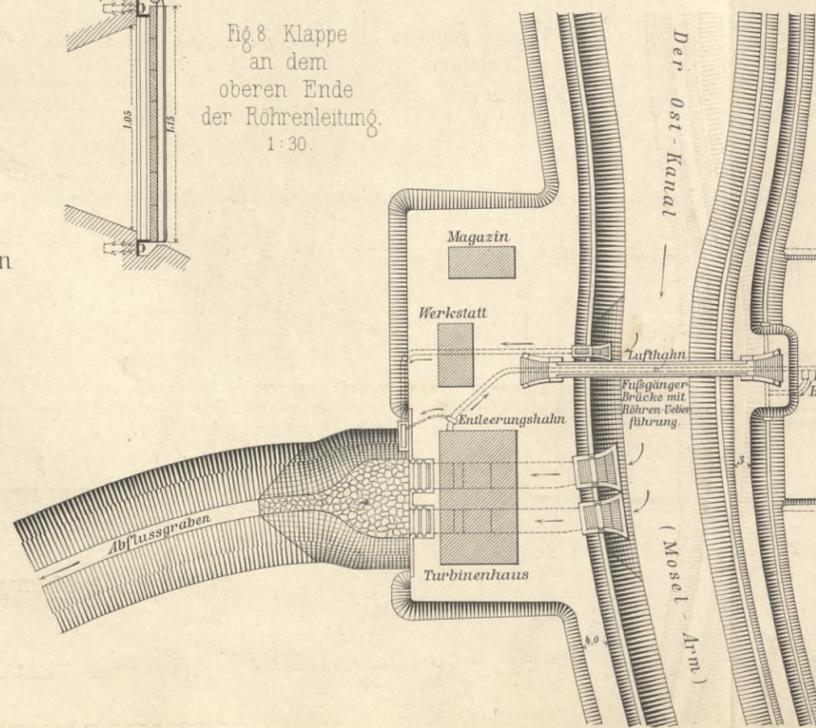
Lageplan des Turbinen-Pumpwerks bei Valcourt. 1:1000.
